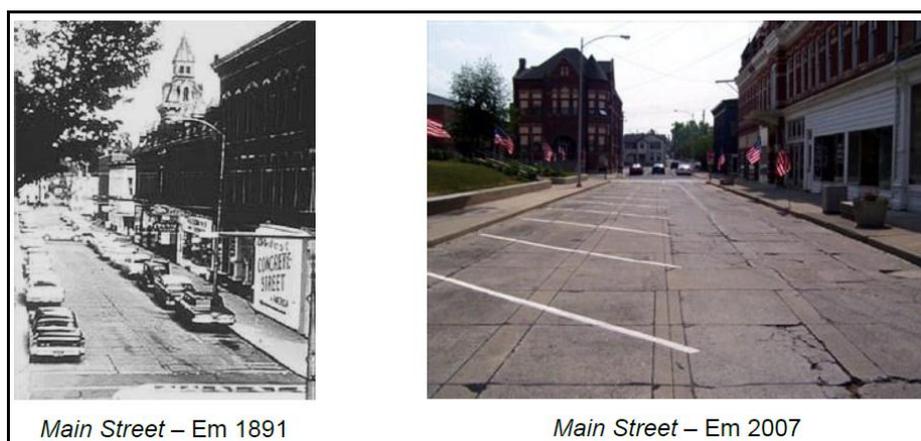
Primeiro pavimento rodoviário de concreto de cimento Portland (Cunha, 2013)
